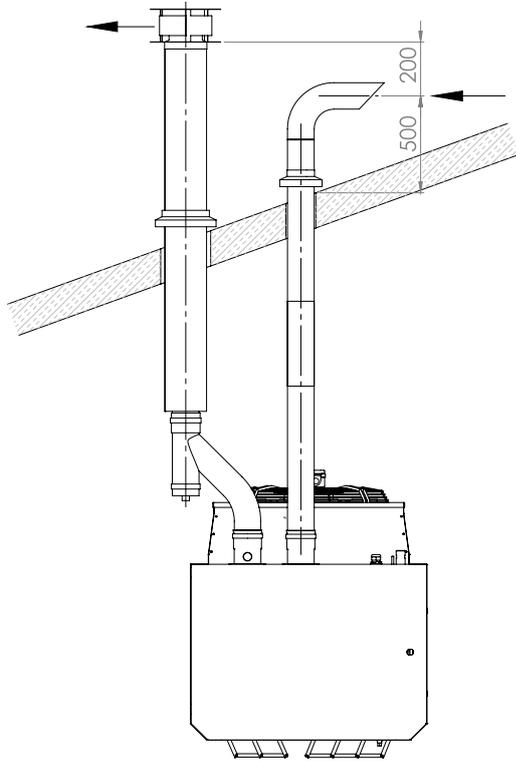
Vertikaler Einbau-Kaminabzug durch das Dach mit separater Absaugung
